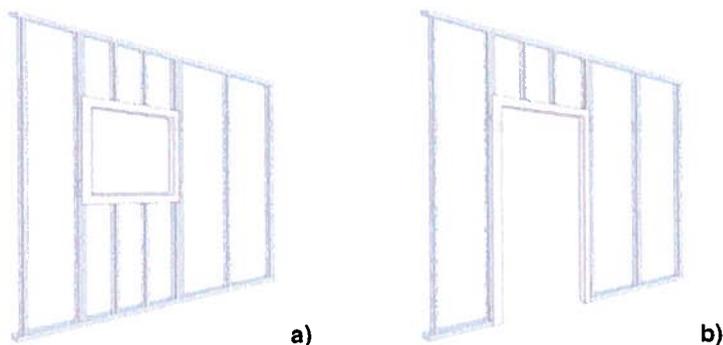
Estrutura metálica em: a) janelas; b) portas.
